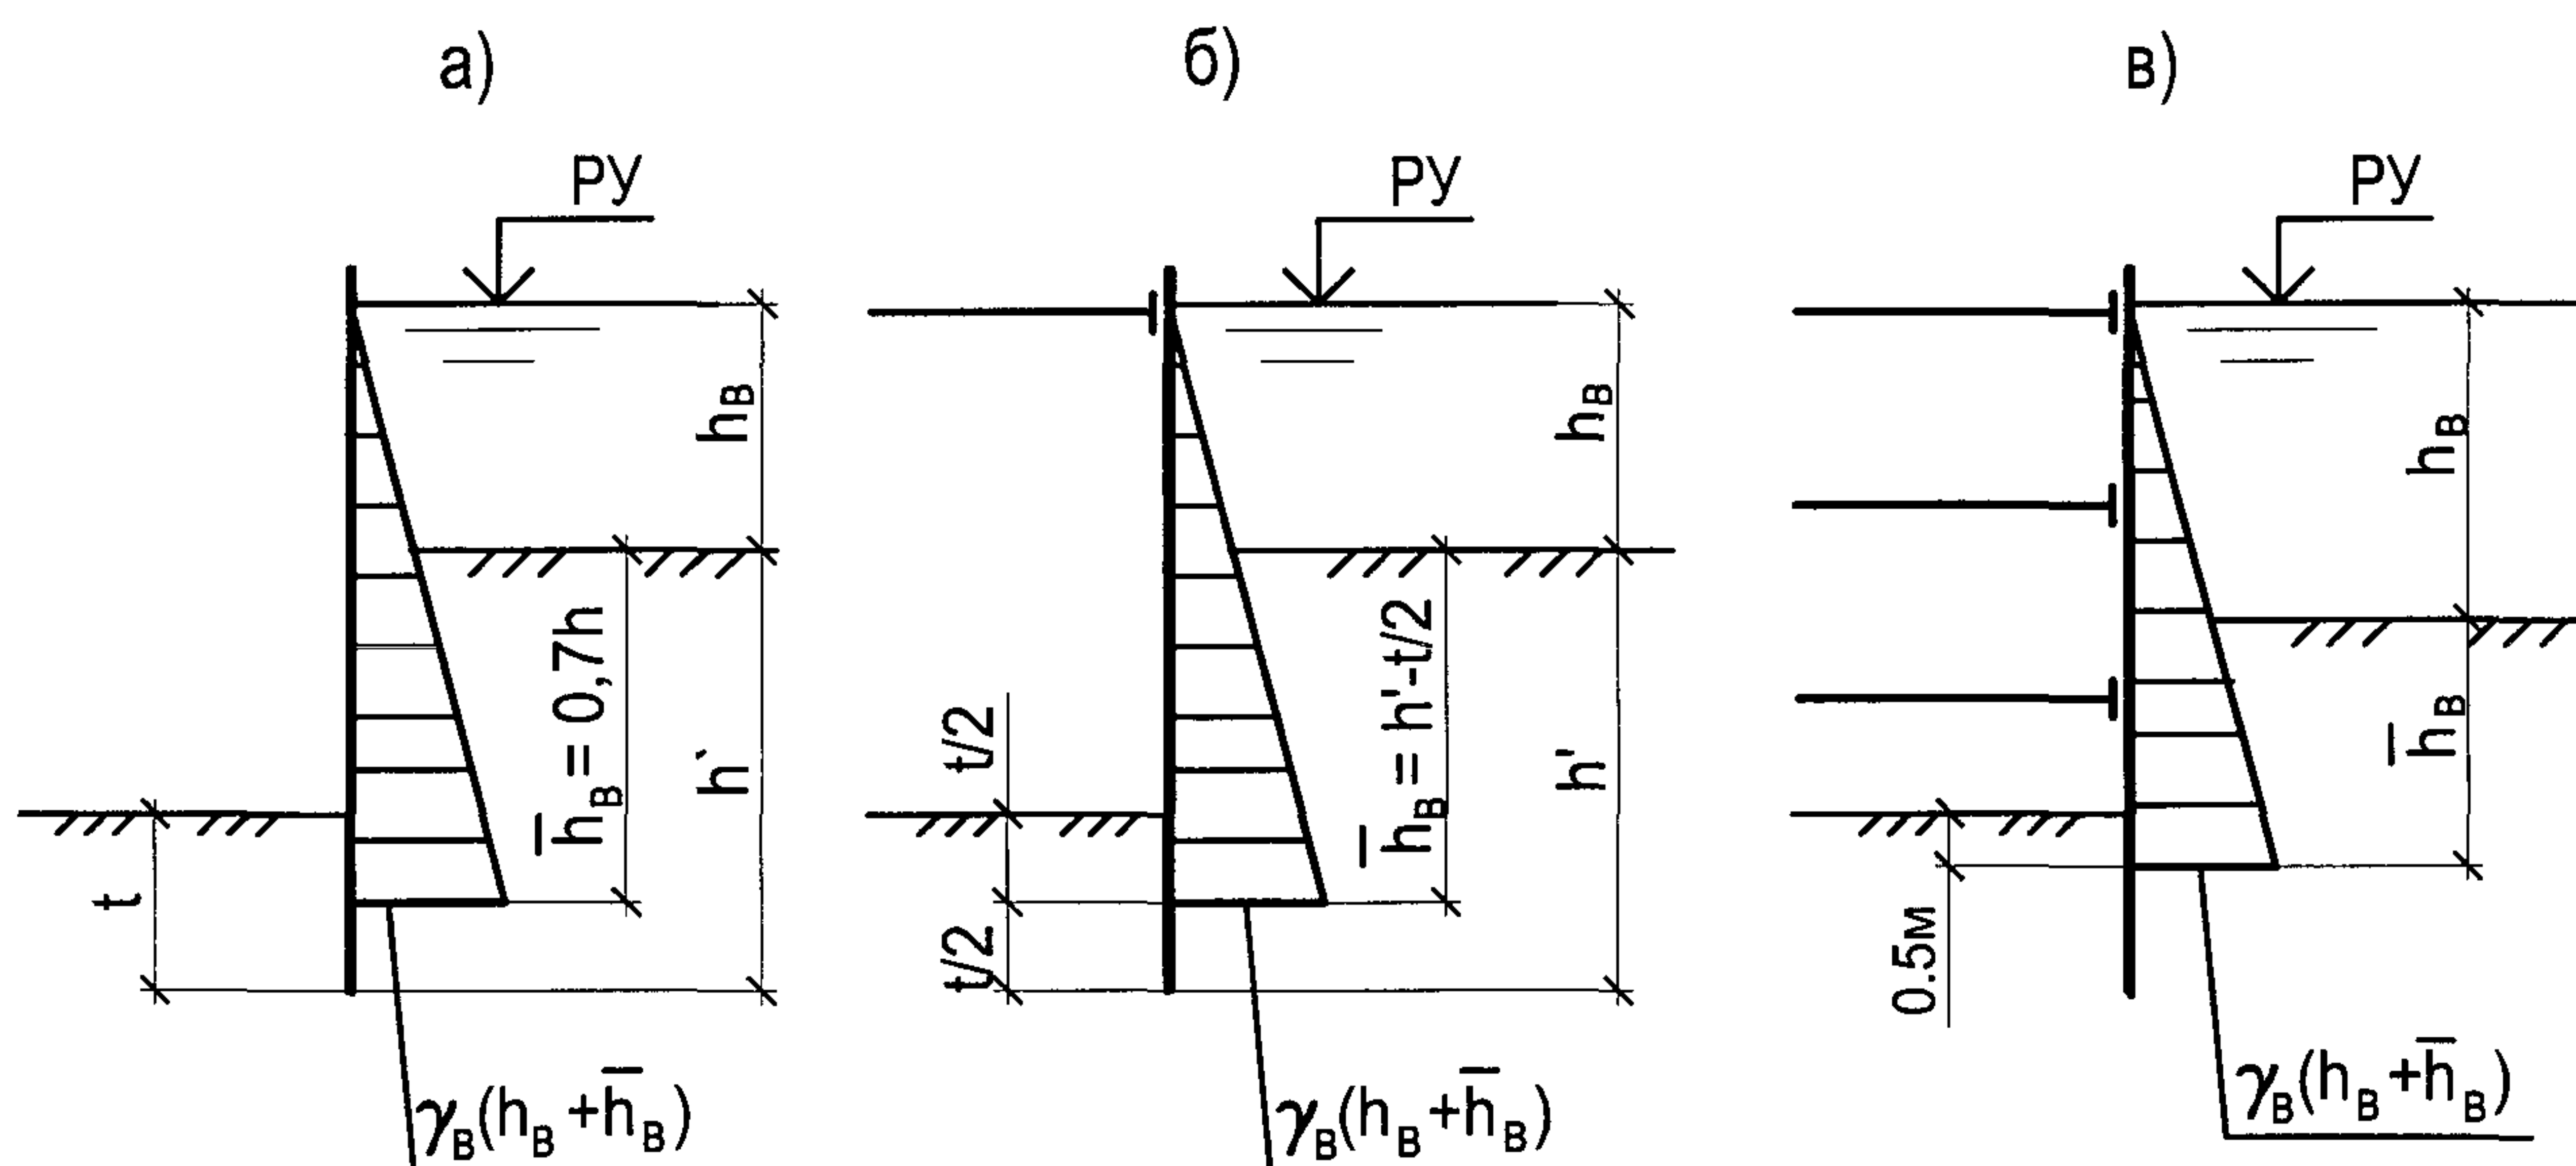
Схемы для определения глубины проникания воды между шпунтовой стенкой и водонепроницаемым грунтом
